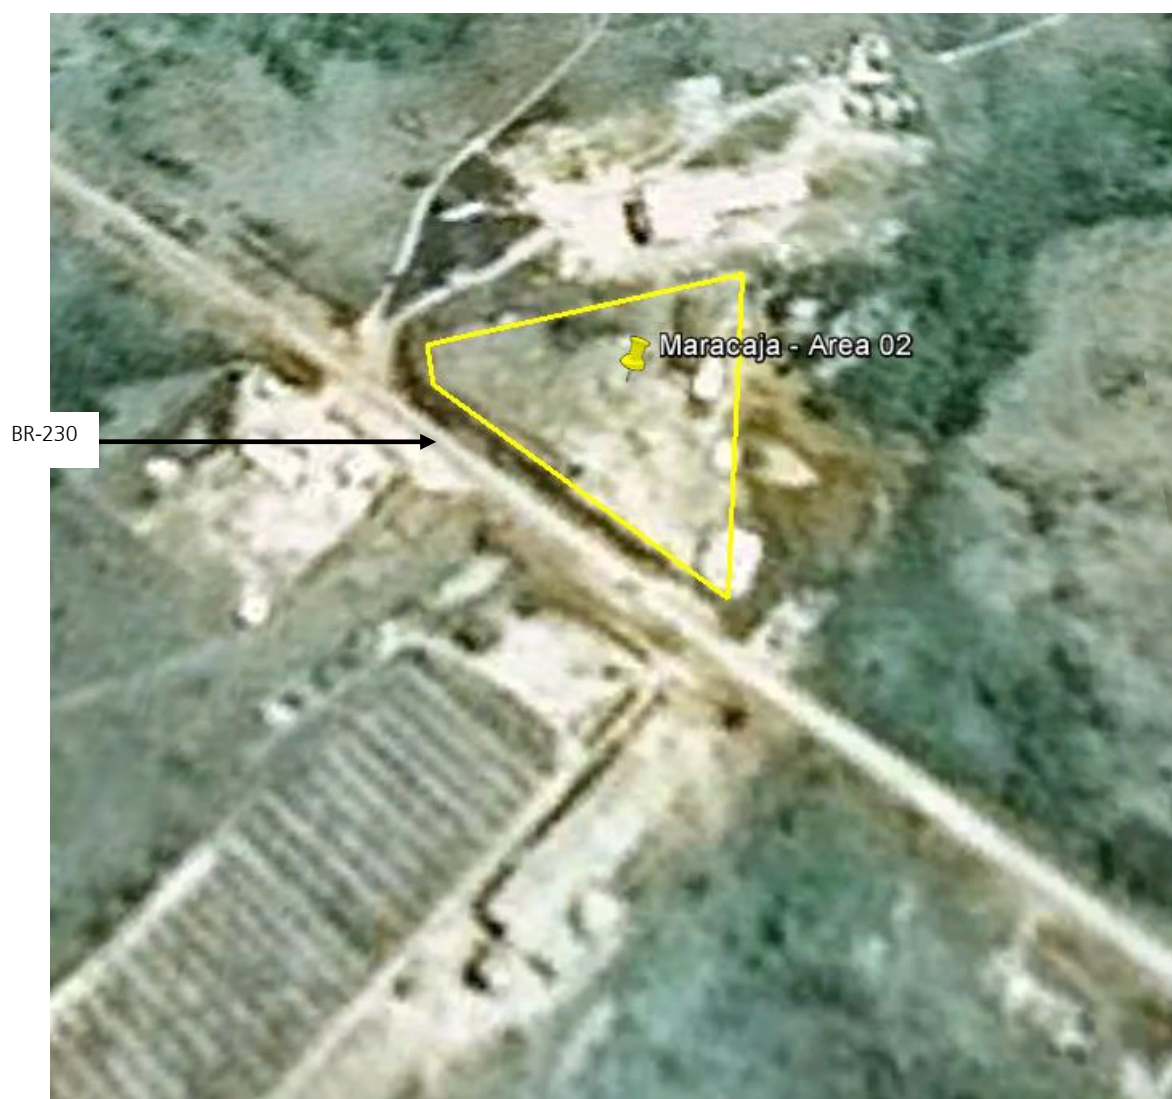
Acesso ao canteiro de Obra “Maracajá – Área 02”
